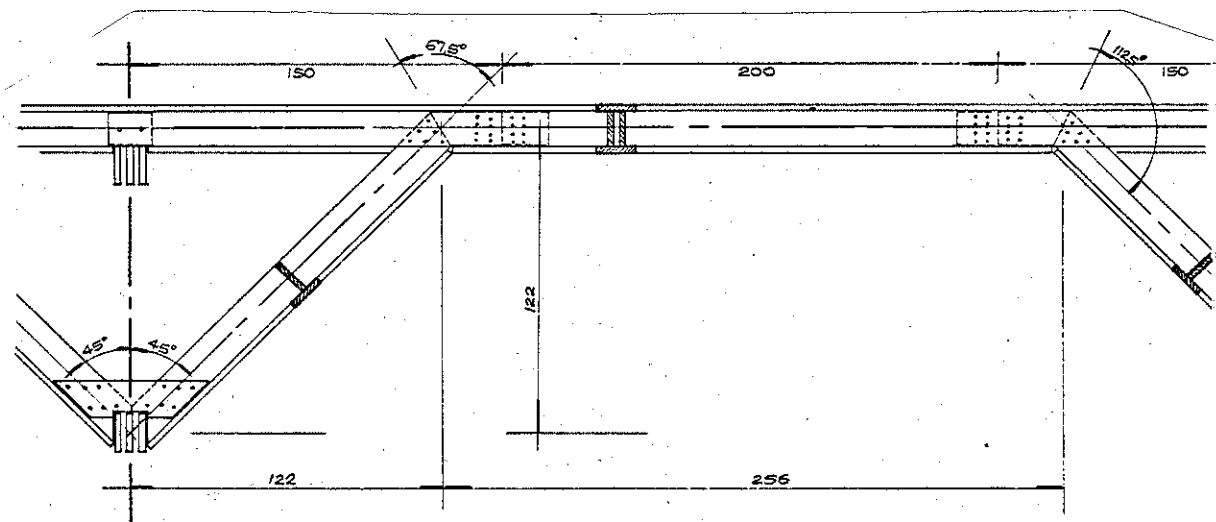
Detalhes da Terça de Contraventamento
